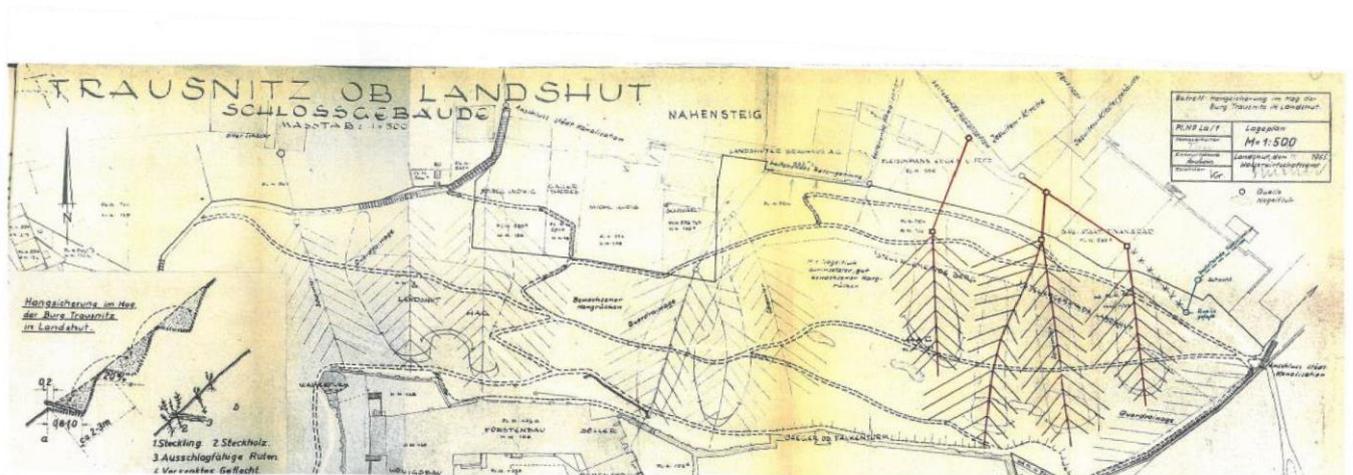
Fassungs-systeme mit Fischgrätenaufbau
